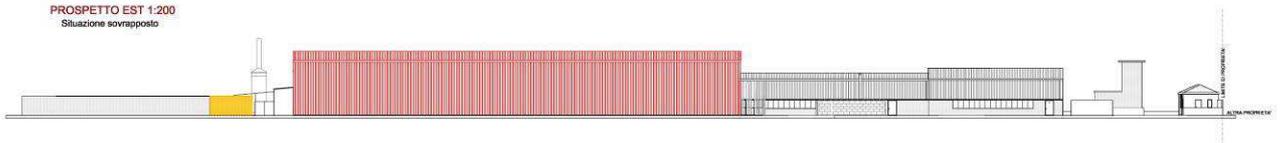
prospetti dell'area dell'area di intervento (in rosso l'ampliamento previsto)
